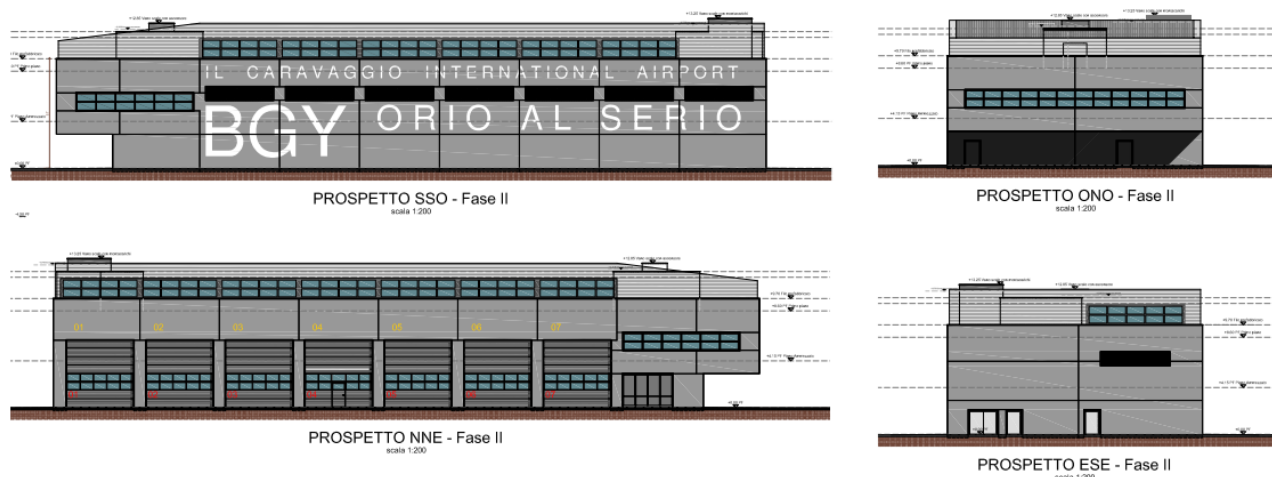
Intervento C1: Strutture servizi aviation, prospetti
